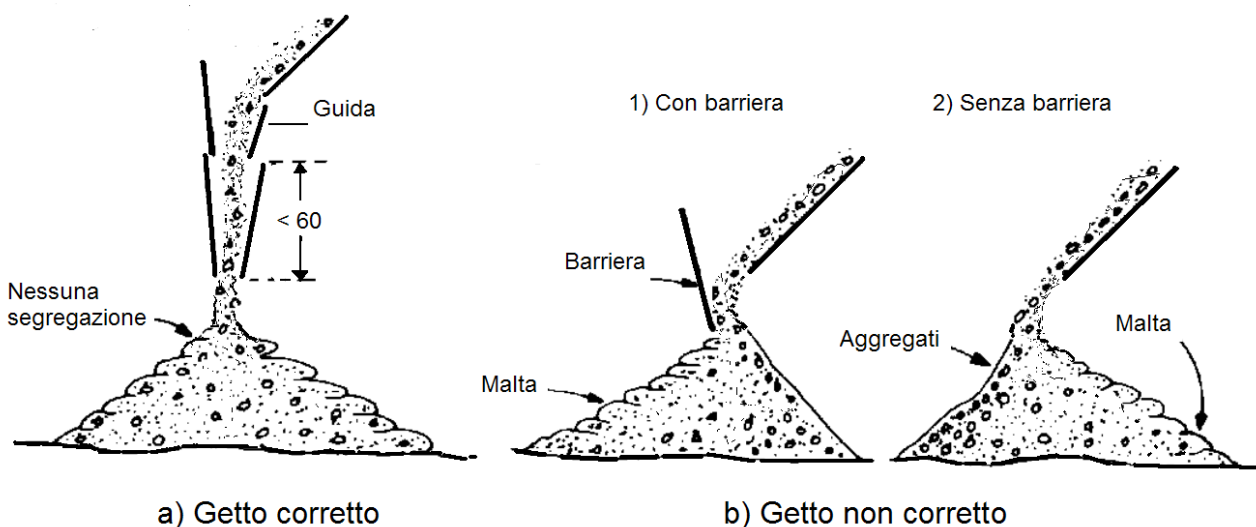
Esempi di getto di calcestruzzo da piano inclinato: a) getto corretto e b) getto non corretto. Nel caso b) si ha la separazione degli aggregati dalla malta cementizia. La barriera comporta soltanto il cambiamento di direzione della segregazione.
